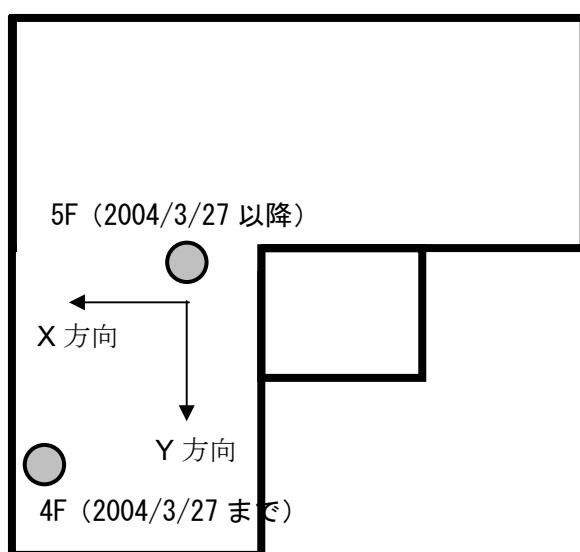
基準階 (2~5 階) 平面図と地震計設置位置 (● 印)
